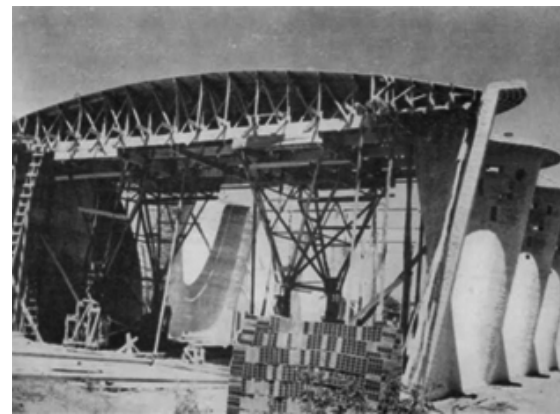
Encofrado para la cubierta al nivel del suelo (1960). Archivo Dieste. (Pedreschi, R. 2008).
